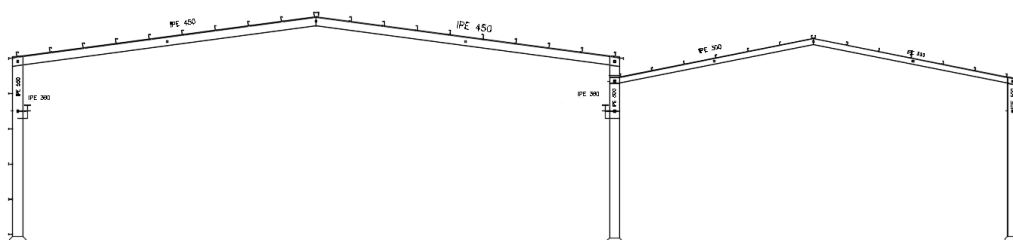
Pórtico Interior con detalle de las correas
